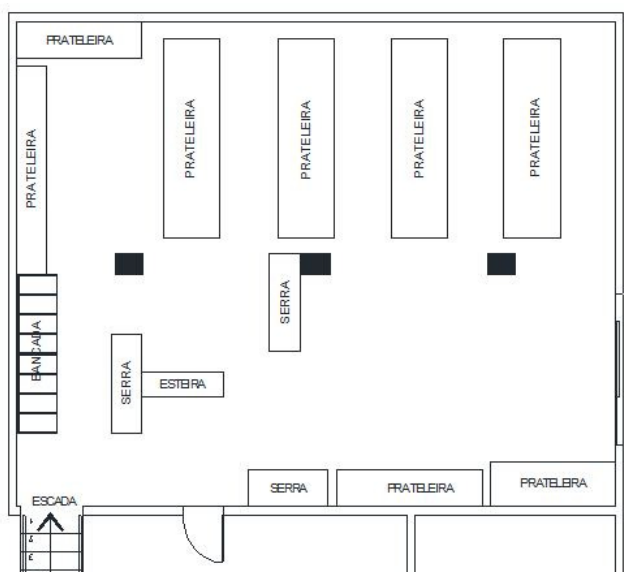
PLANTA BAIXA LAYOUT DO ESTOQUE SITUAÇÃO ATUAL
